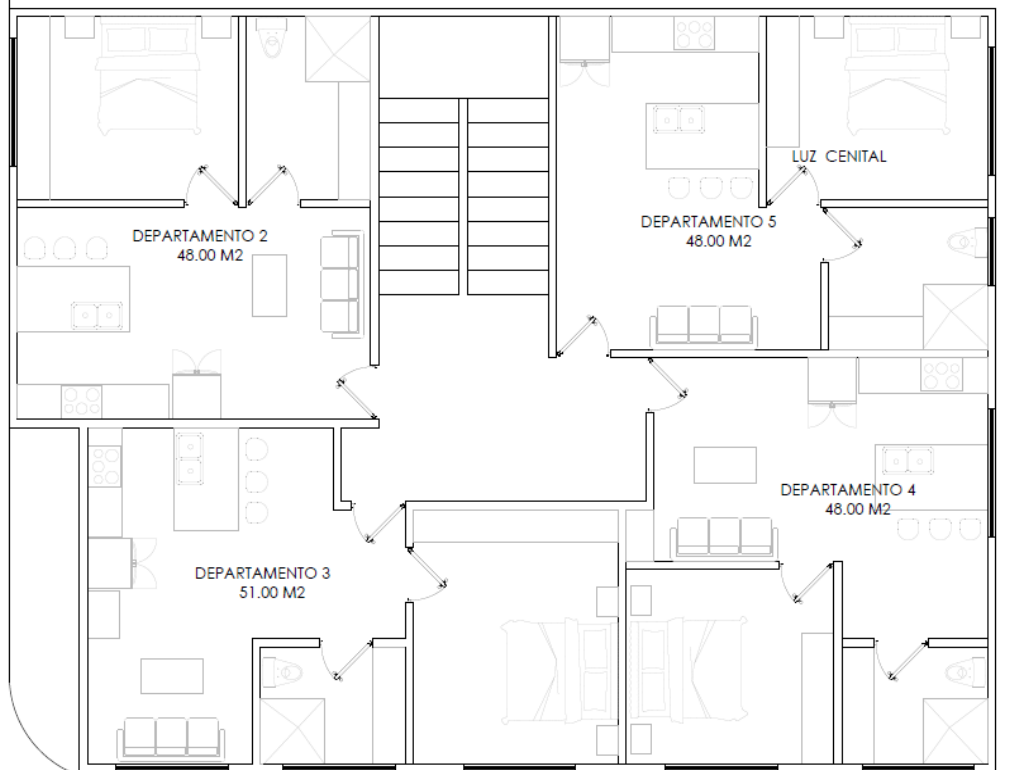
Propuesta de aprovechamiento habitacional plurifamiliar. Planta Baja.
